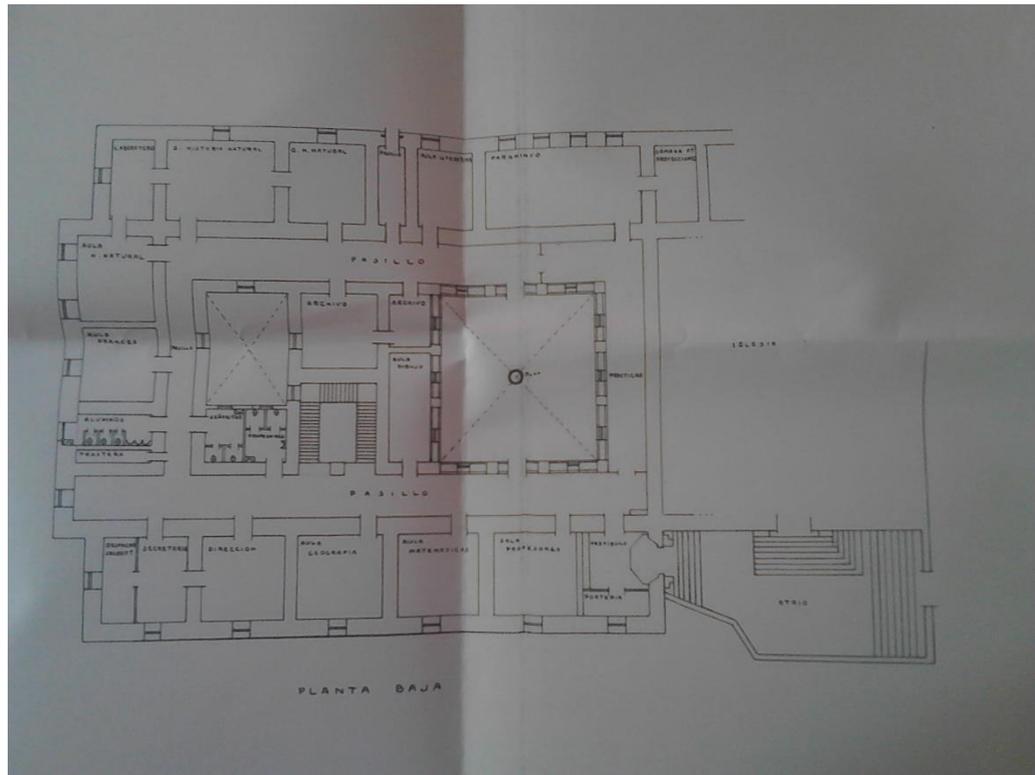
y 13 Planos del proyecto de obra y recuperación del edificio, 1929. Planta principal y baja.
